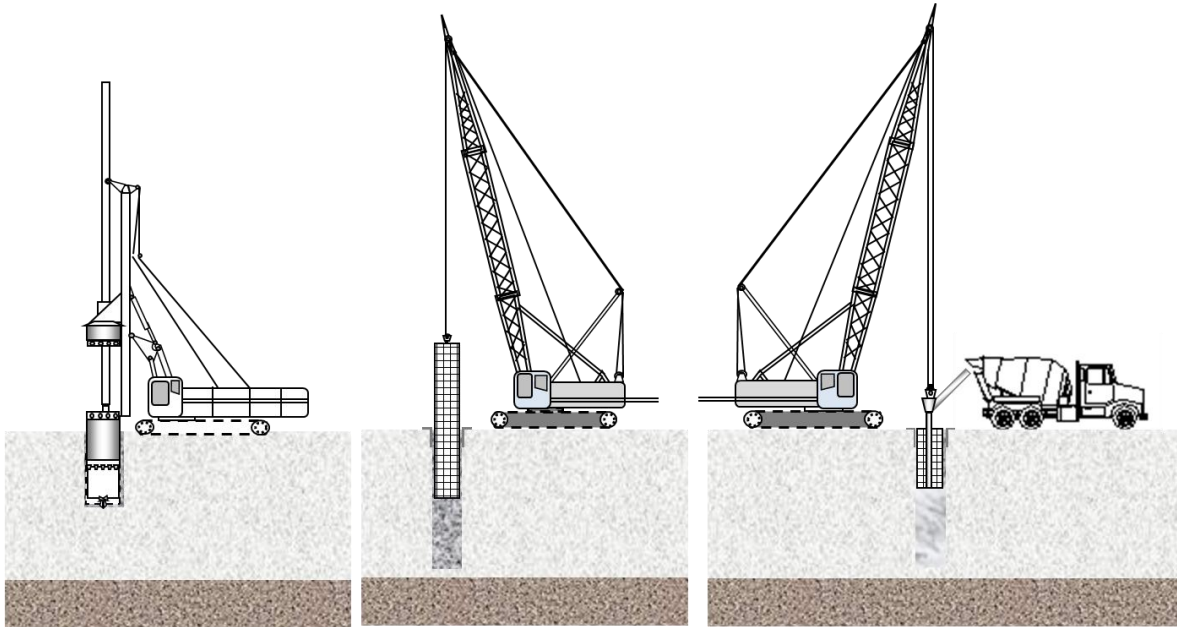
; Se muestra la perforación colocación del acero y colado de las pilas y la excavación, colocado del armado y colado del cajón de cimentación.
